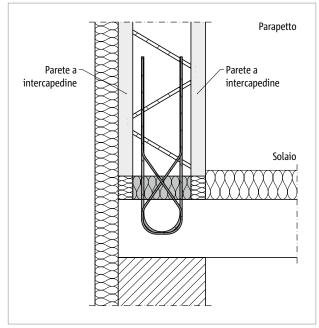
Schöck Isokorb® T tipo AP disposizione verticale: raccordo di una parete a intercapedine
